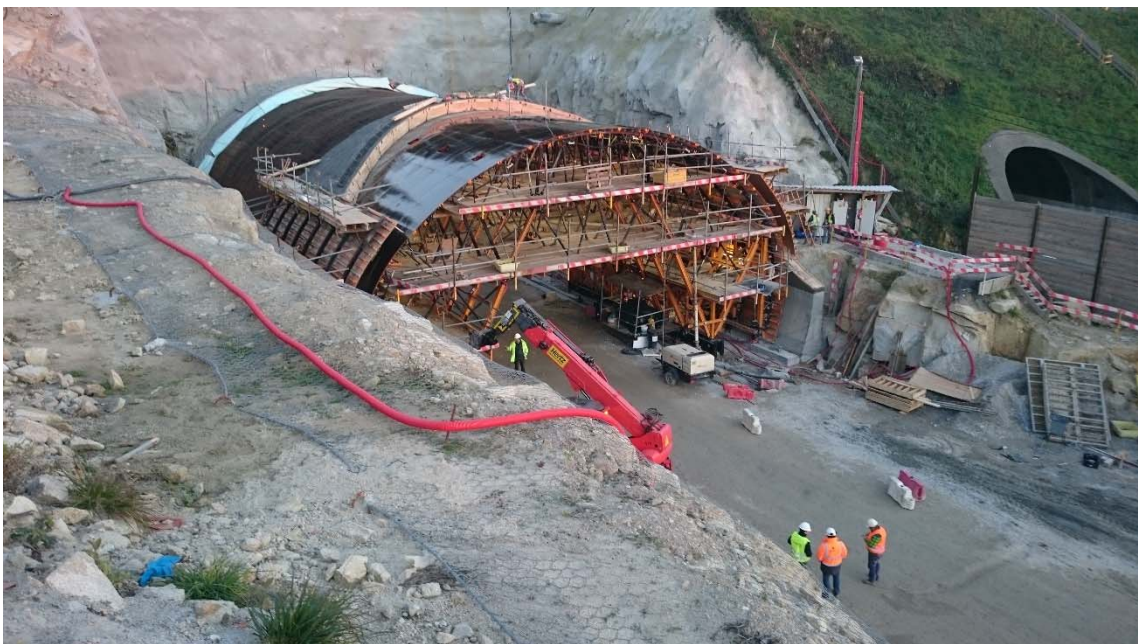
Betonagem da abóbada do 1º tramo (TAS 18/01/2017)
